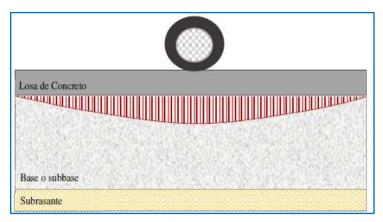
Estructura y distribución de cargas en pavimento rígido *Fuente: Espinoza & Vargas, 2020
